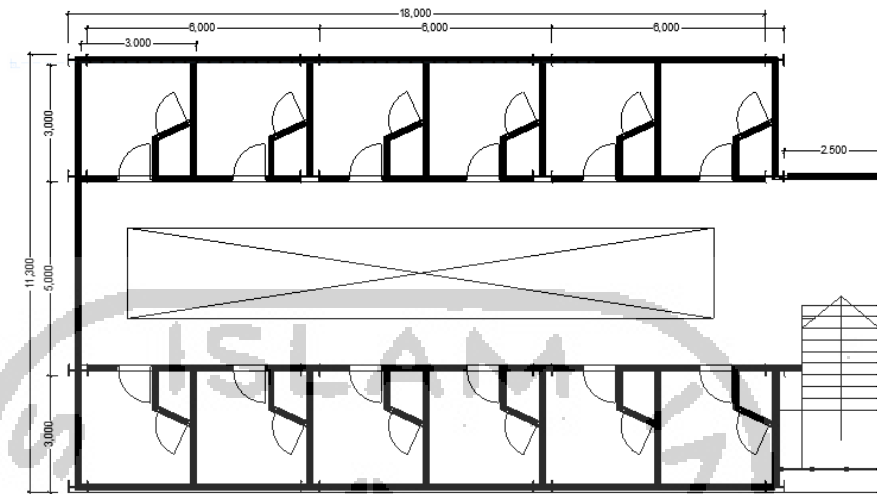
3 Denah Skematik Hunian Ground Floor
